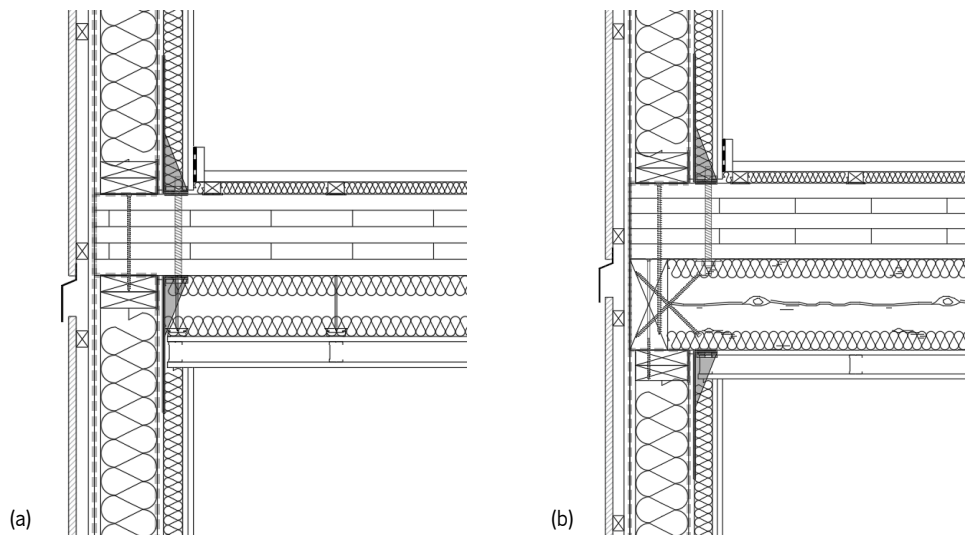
Junção entre paredes em *timber-frame* e piso em CLT. (a) apoiado diretamente sobre as paredes e (b) apoiado sobre as vigas de coroamento. Exemplo: Par_Ext_TF e Pav_Int_CLT
